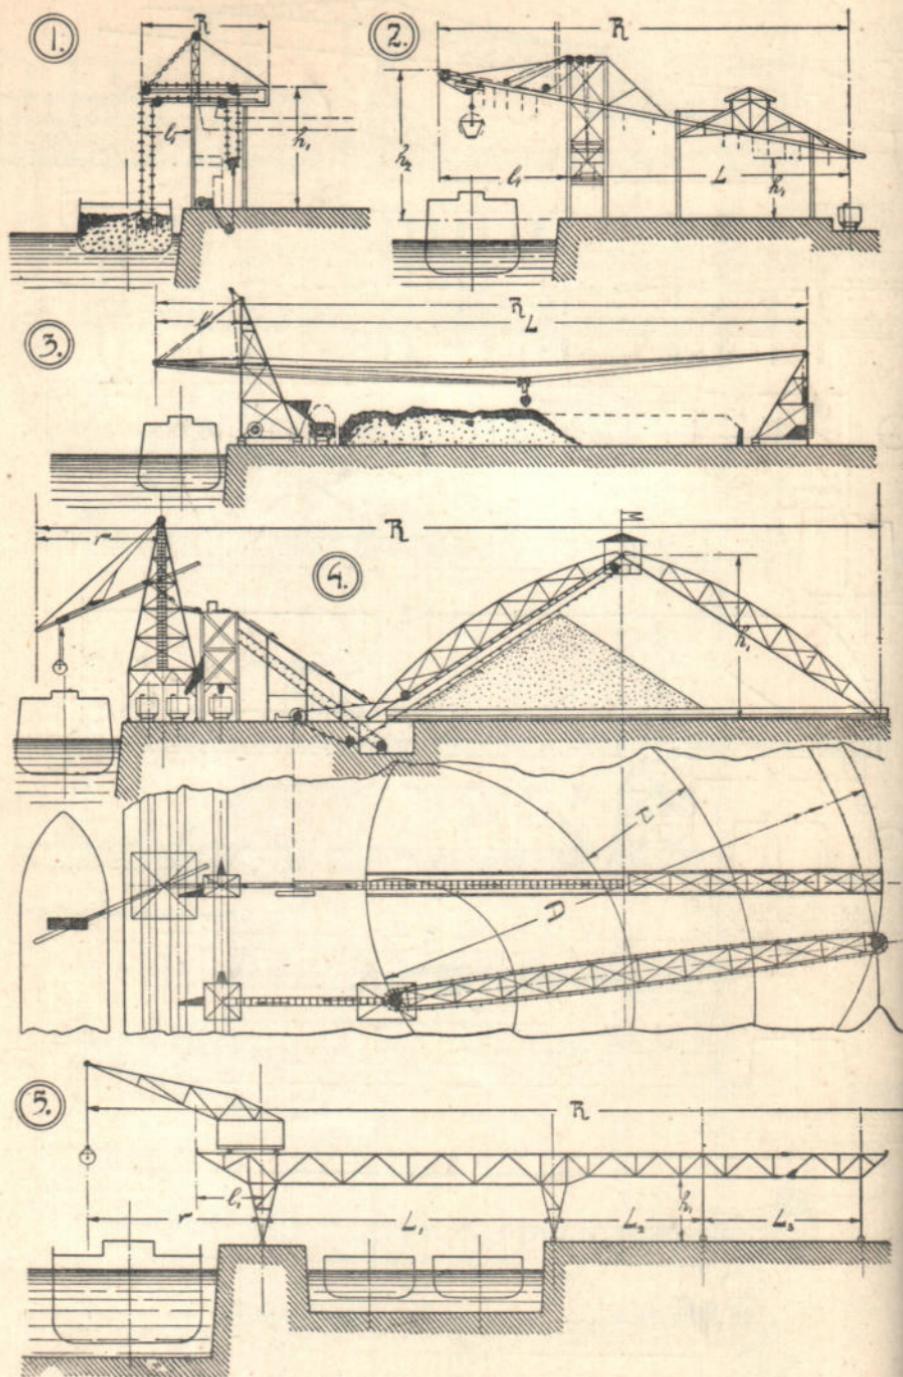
Схемы крановых установок для выгрузки угля или руды из судна на берег.
